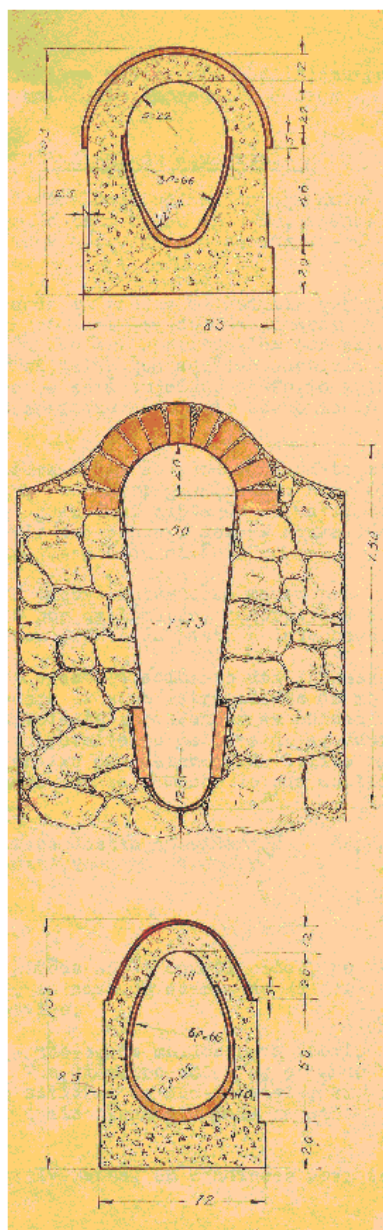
Secções do aqueduto construído de betão (CABRITA, 1928-29), em cima e em baixo, e de alvenaria com abóbada de tijolos, a meio (CABRAL; MANUEL, 1879).
